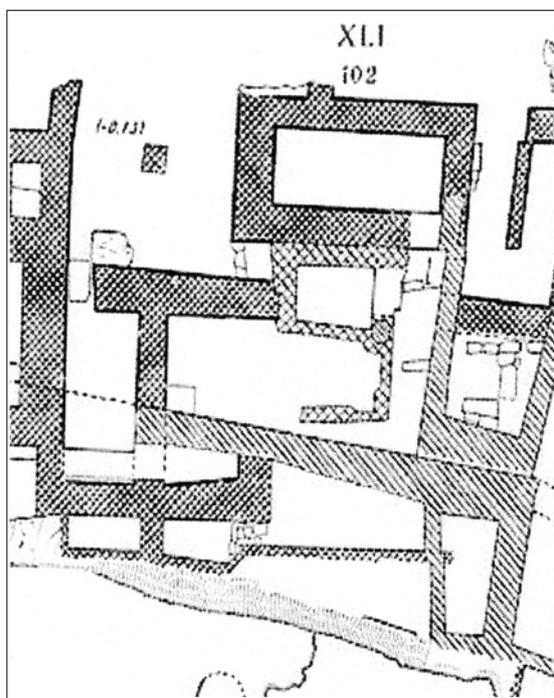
Vano 102. Planimetria Stefani (dettaglio fig. 2)
